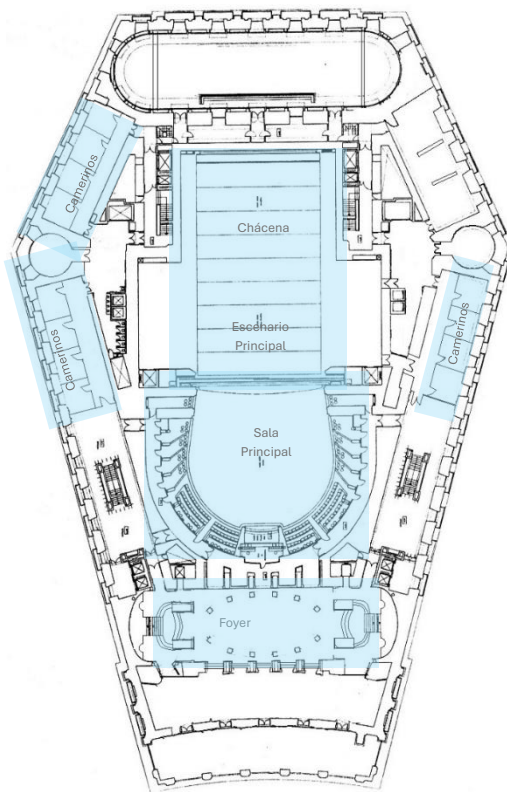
Planta 0: camerinos individuales y sala principal [13]
